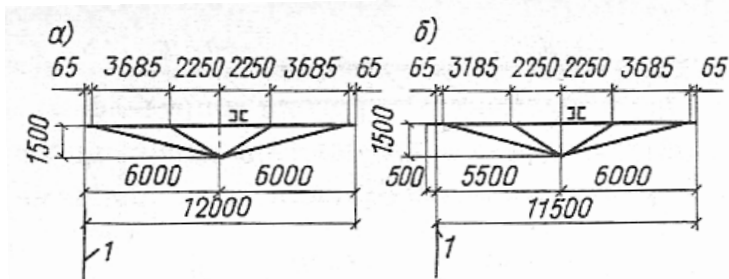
Схемы решетчатых прогонов: а) рядовой; б) крайний (у торцов и ТДШ); 1 – ось стропильной фермы
